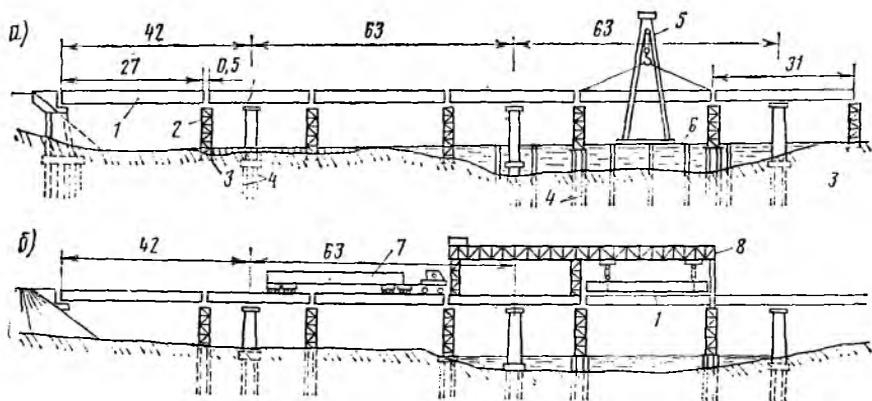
Схема монтажа балочно-неразрезного пролетного строения из крупных блоков-балок:
